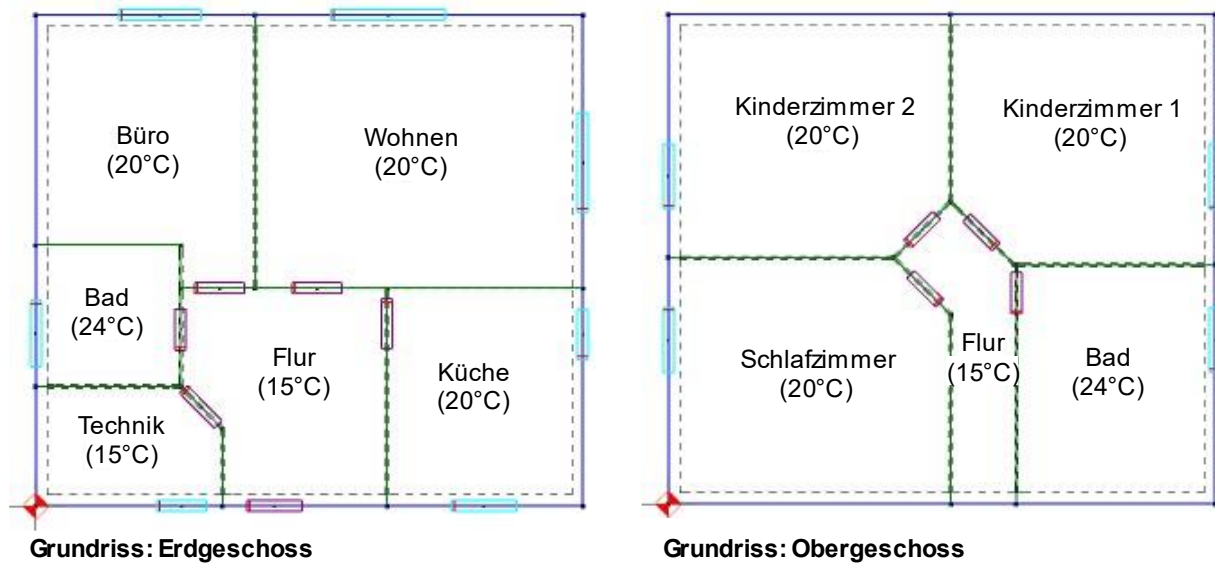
Grundriss EFH, eigene Darstellung nach (Hartmann, et al., 2016)
